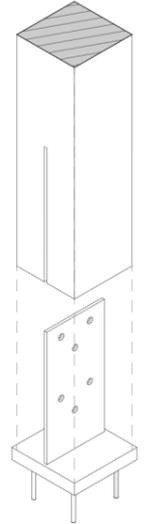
Detalle unión columna-loza. Fuente: Elaboración propia
